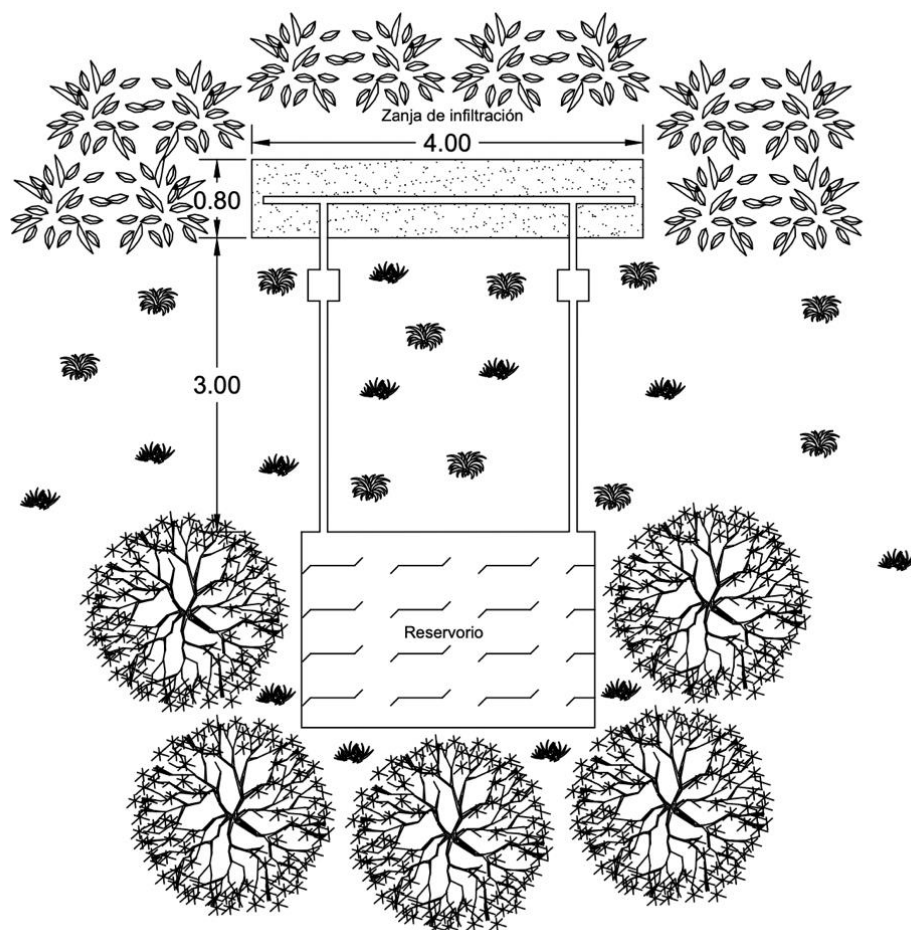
Zanja de infiltración vista en planta. Fuente. Gamboa, 2023
